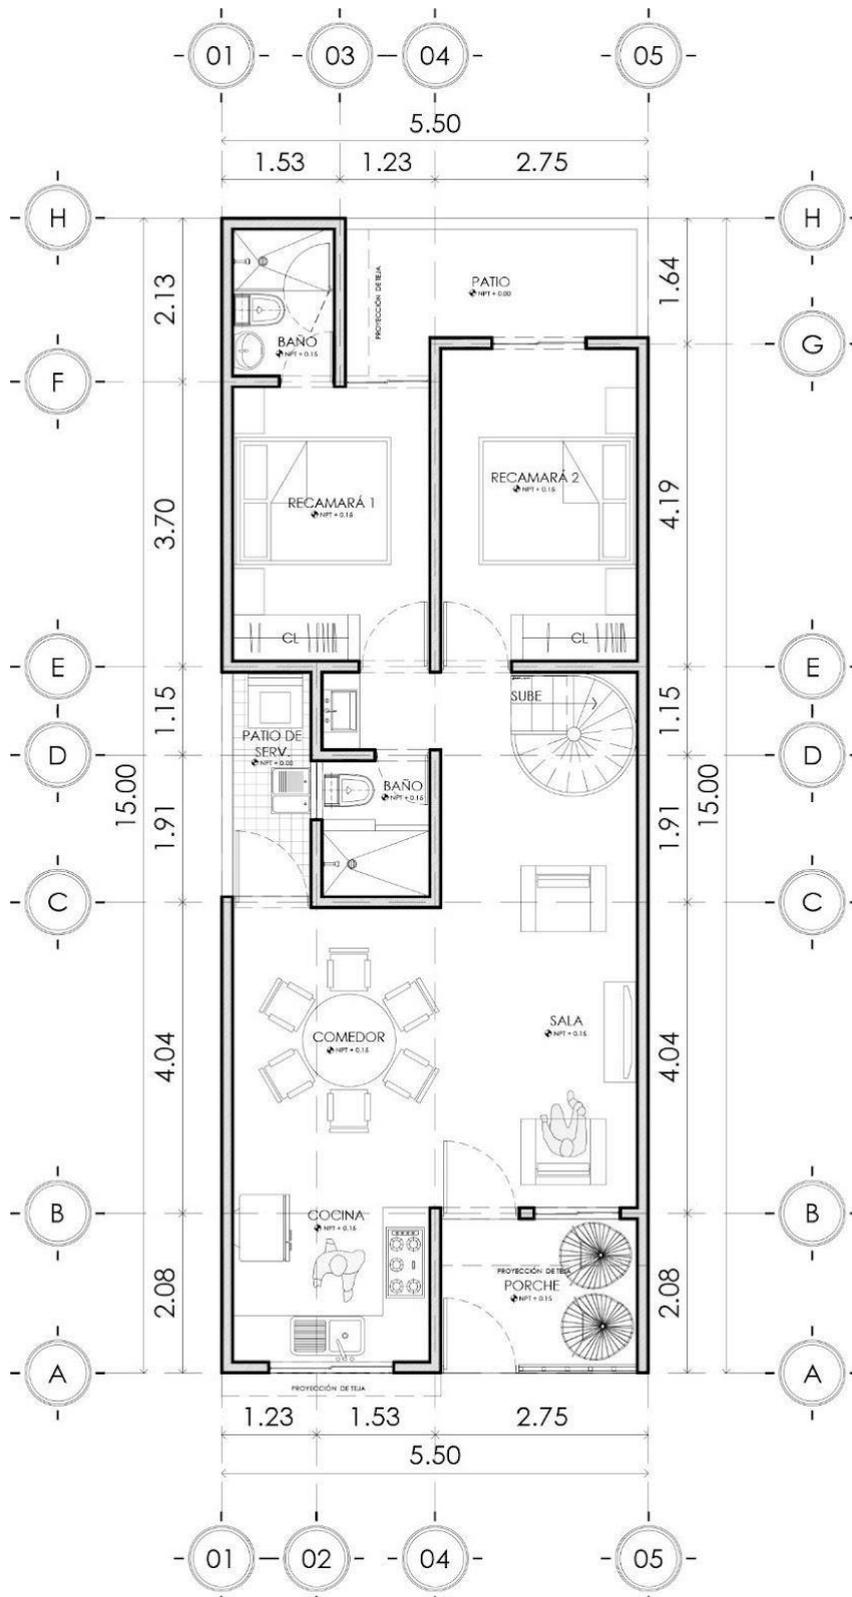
Propuesta de planta Baja Natalia Bianidxi Cupul Ramírez, 2022.
